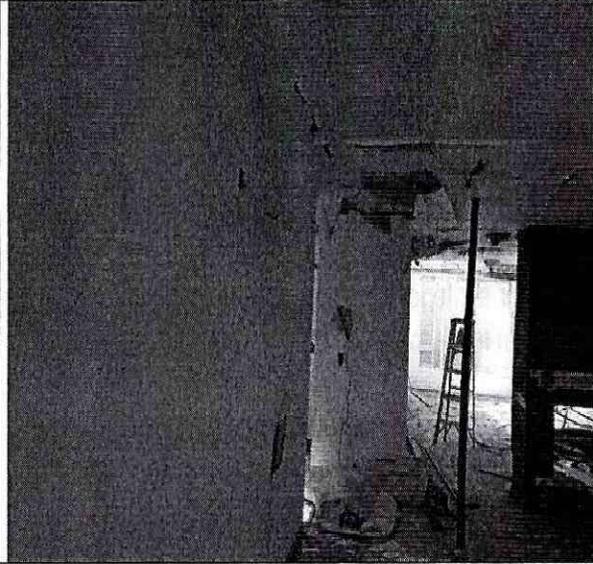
Grietas en muros y daños en placa de entepiso.
